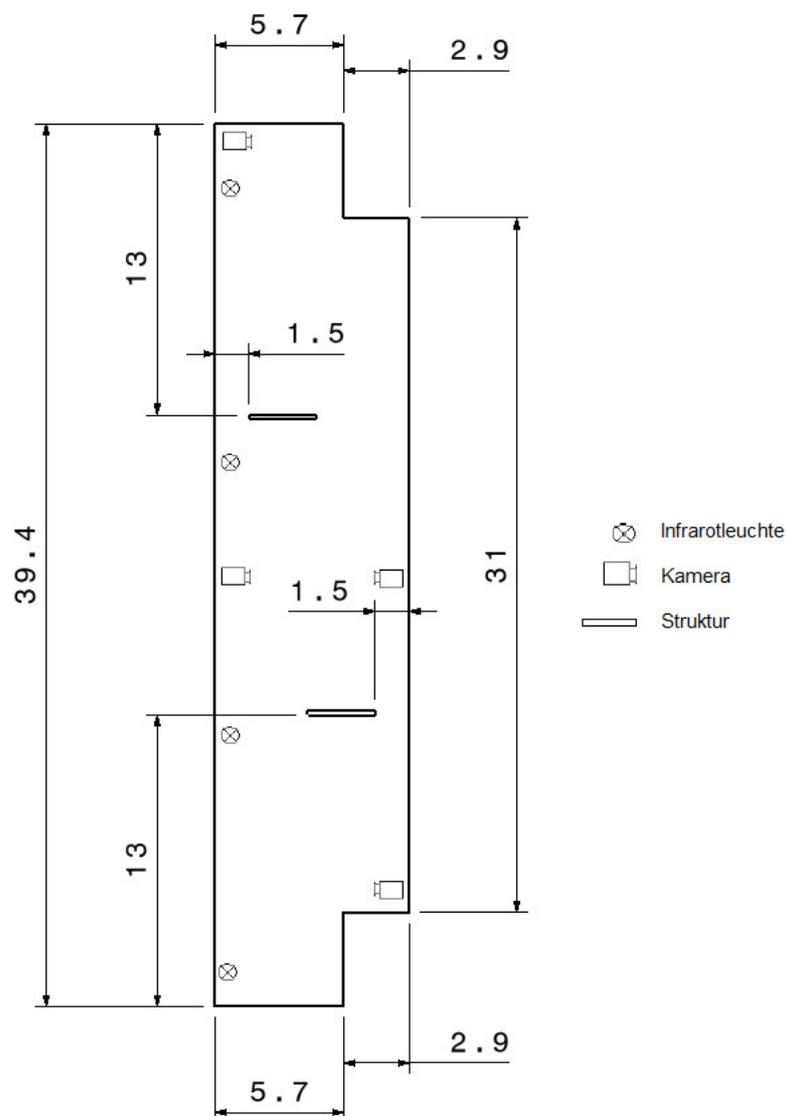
Grundriss des Stalls mit den Araberstuten (inkl. Strukturelementen, Kameras und Infrarotstrahlern; Angaben in m)
